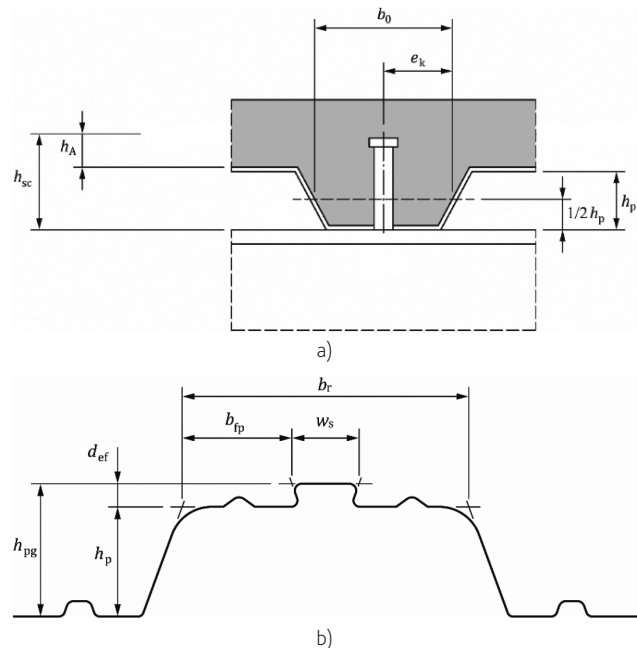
a) Perno soldado, centrado numa nervura orientada transversalmente à viga metálica; b) Secção transversal de uma chapa perfilada com reforço reentrante posicionado no banzo superior [6]
